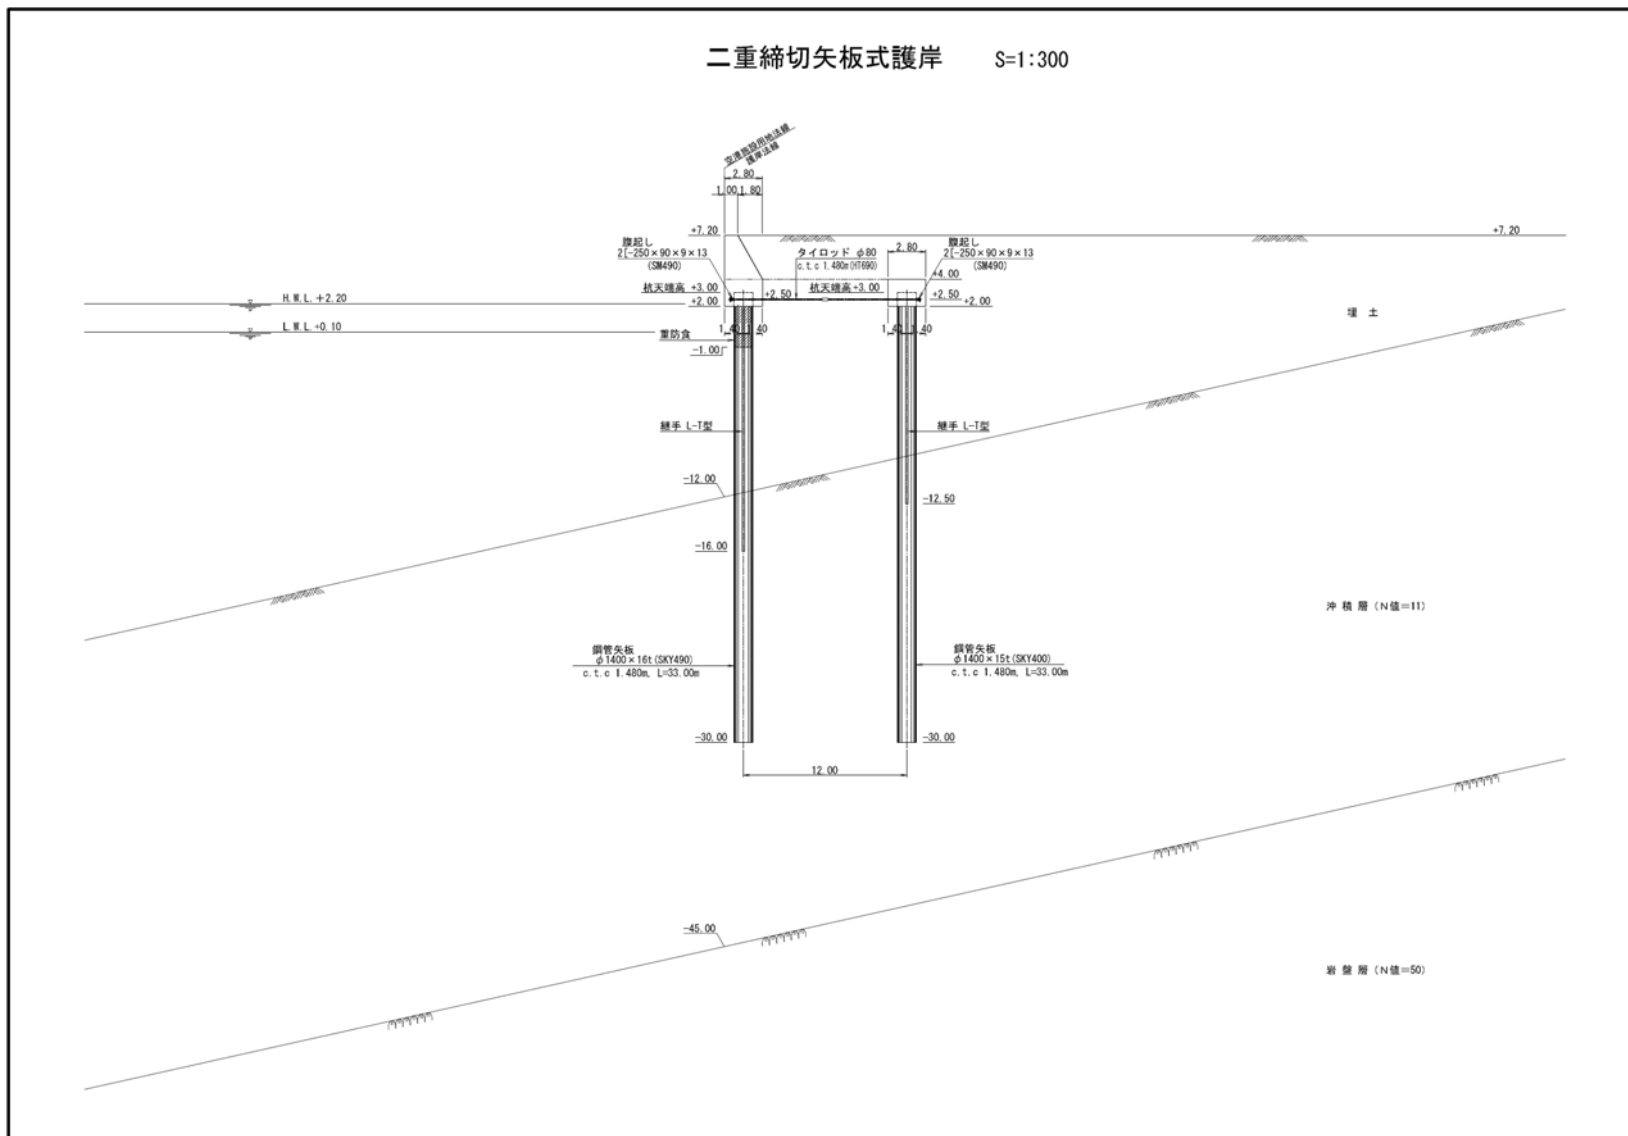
代替施設本体の二重締切矢板式護岸断面図
